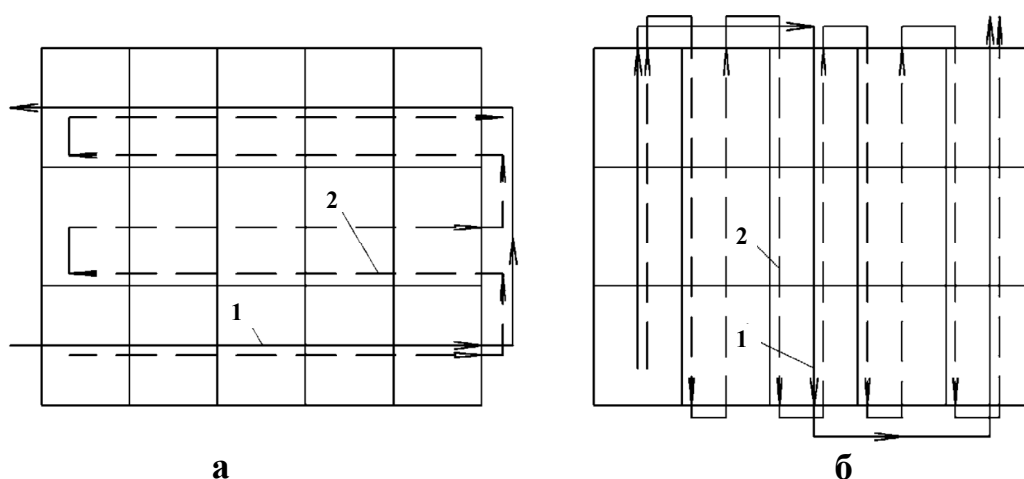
Схеми руху кранів під час монтажу багатопрогонних промислових будівель:
